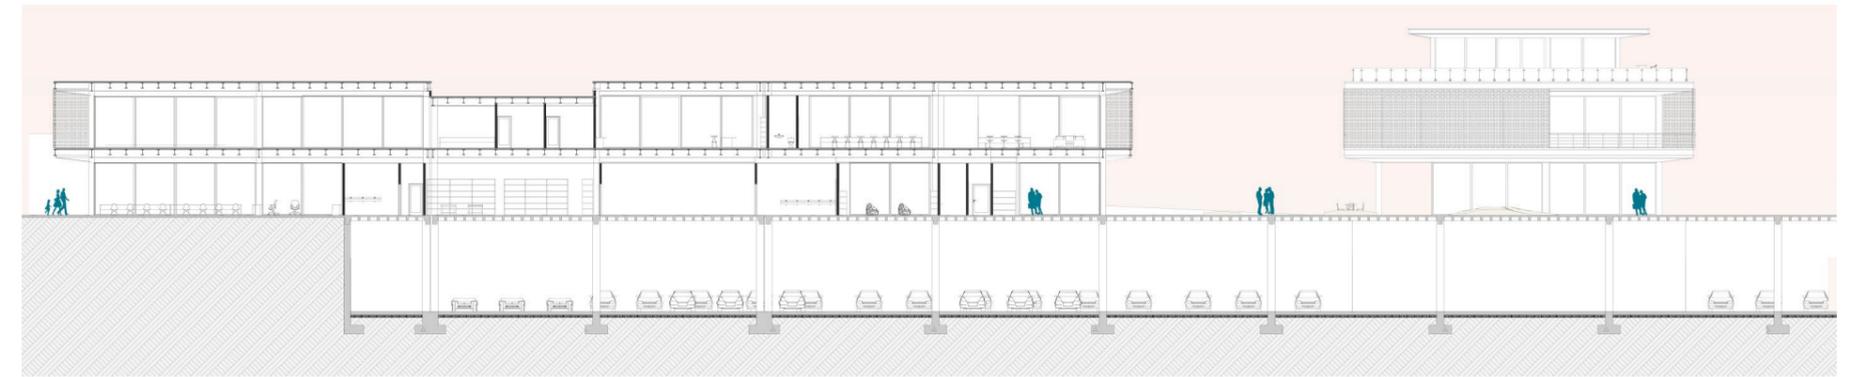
Sección longitudinal bloque central Fuente: Propia, 2022
